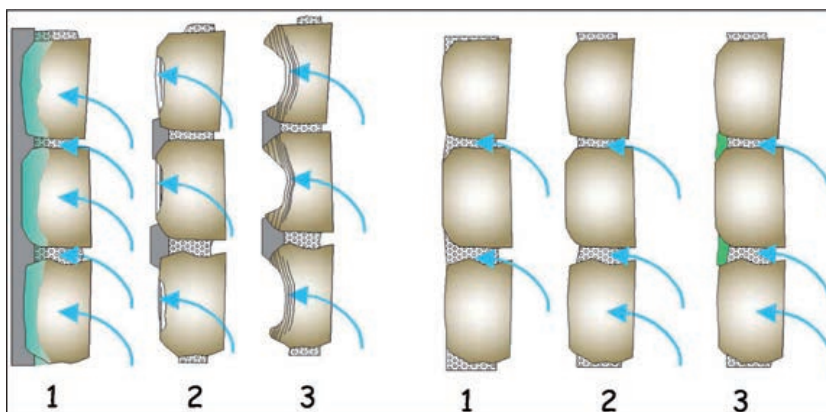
LAVADO DE LLAGAS EN BÓVEDA DE SILLERÍA.
